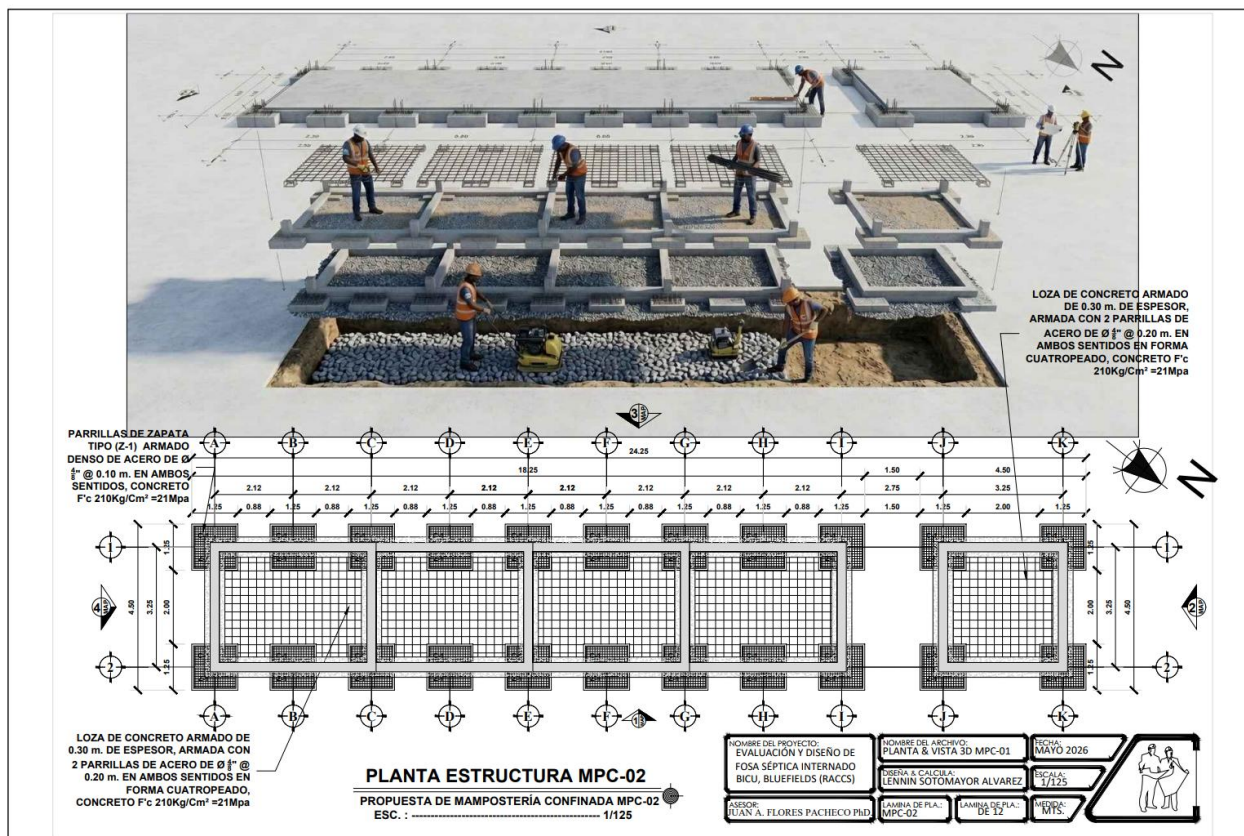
Planta estructural y visualización constructiva de la alternativa en mampostería confinada para el sistema séptico del internado de BICU.
